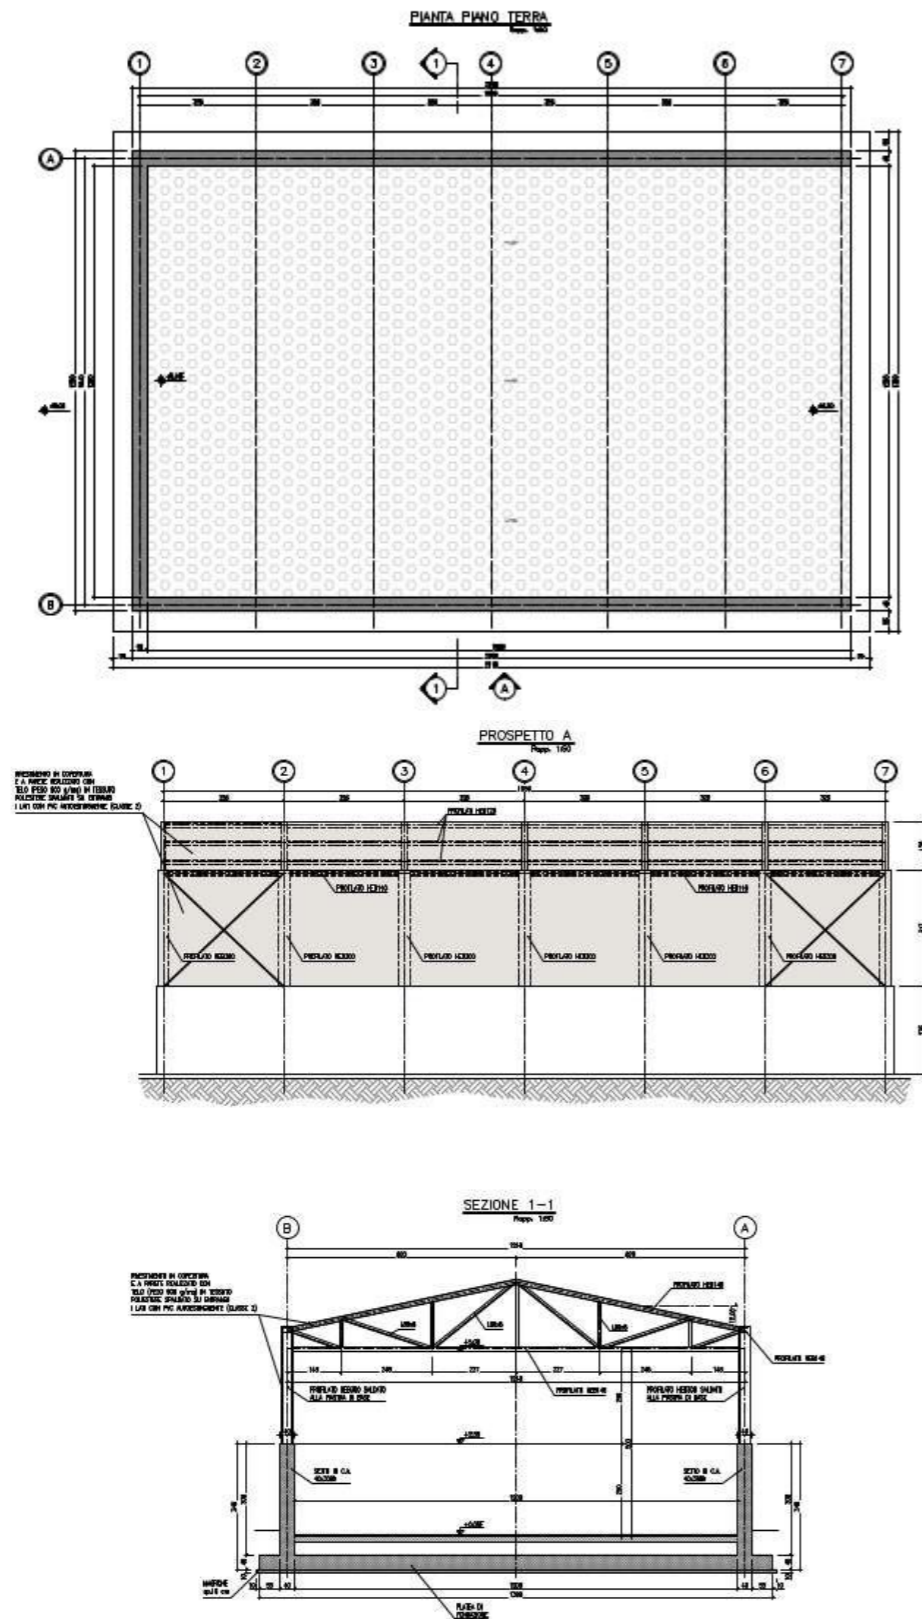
Deposito sale – Pianta, prospetti e sezione
